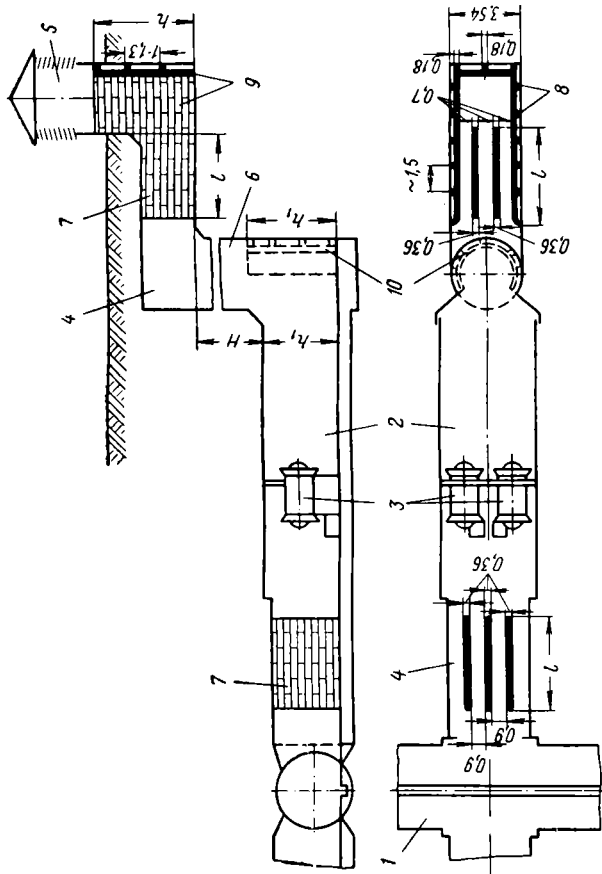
Схема размещения пластинчатых глушителей шума из бетонных шумопоглощающих блоков в вентиляционной установке тоннельной вентиляции, расположенной на перегоне глубокого заложения на уровне и сбоку путей тоннелей метрополитена:
